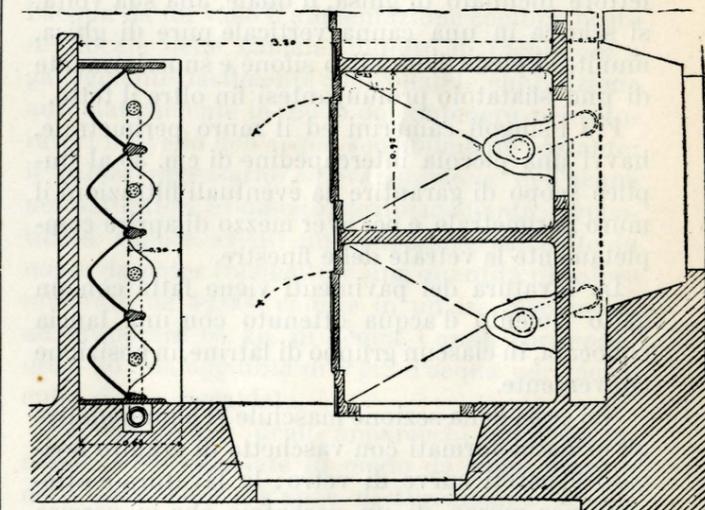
Pianta di un tratto del locale dei cessi e degli orinatoi.
